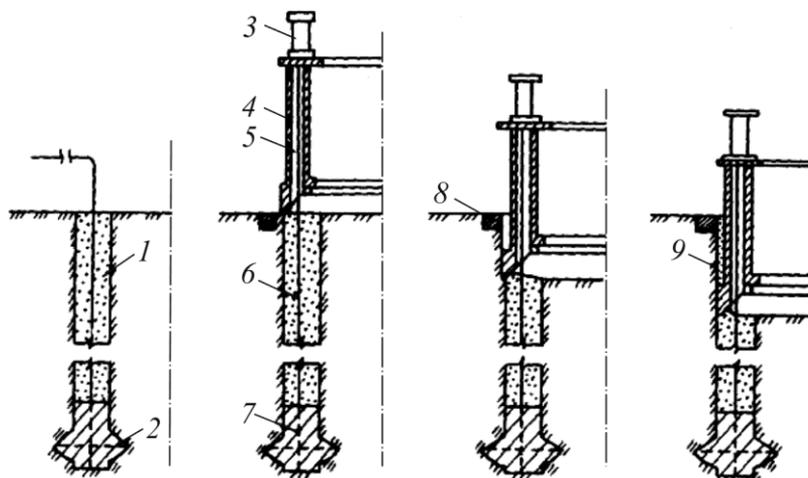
Технологическая схема строительства опускного колодца методом регулируемого погружения: 1 – скважина; 2 – уширение скважины; 3 – домкрат; 4 – стена колодца; 5 – канал в стене; 6 – канат; 7 – анкерное устройство; 8 – форшахта; 9 – тиксотропная рубашка
